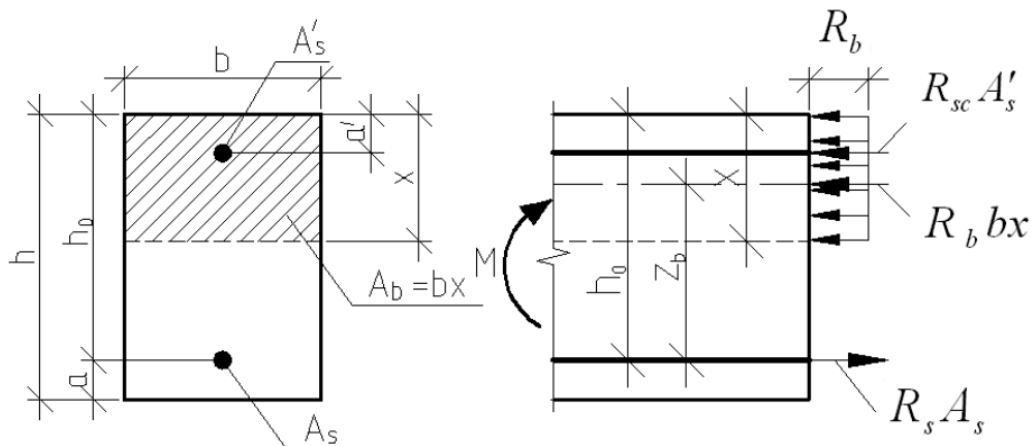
Схема усилий в нормальном сечении изгибаемого элемента с двойной арматурой.
